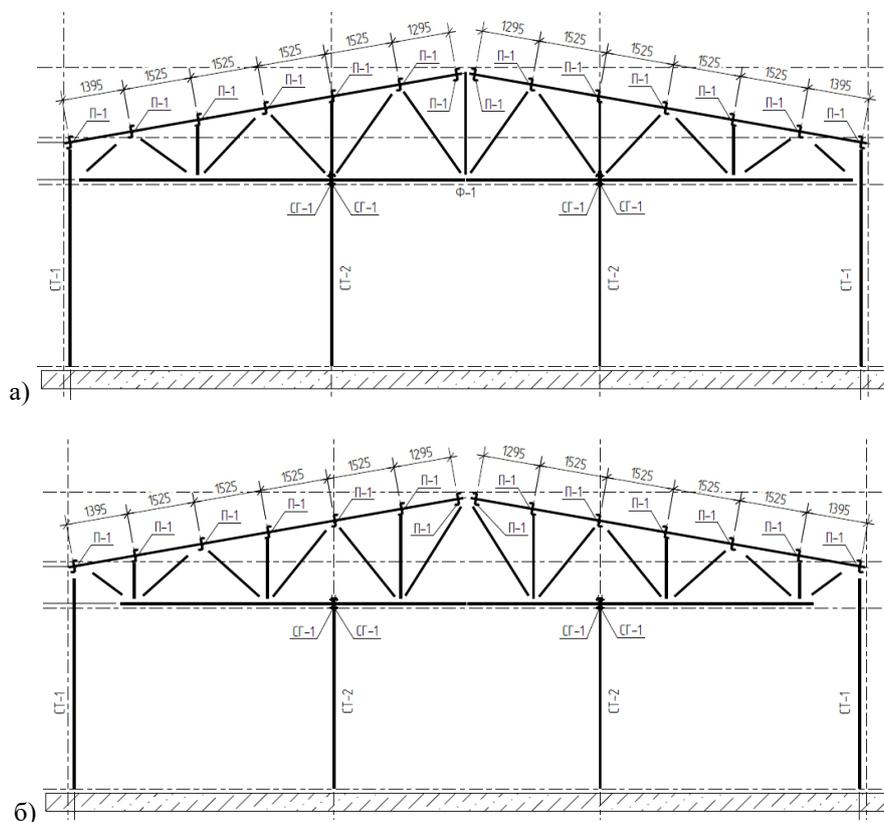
Конструкции покрытия складского здания: а – вариант 1, б – вариант 2
